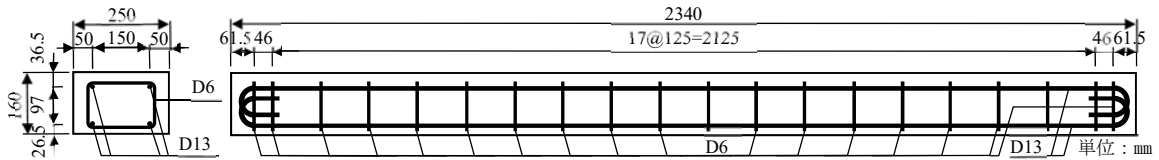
スラブ供試体に用いる鉄筋コンクリート梁の寸法および配筋図
